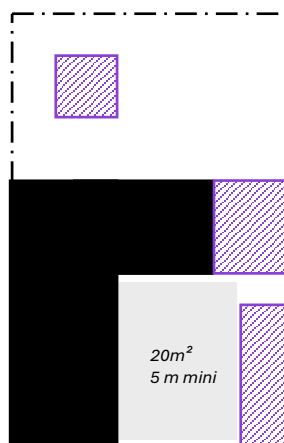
zones d'implantation possibles pour les extensions de la construction existante.
